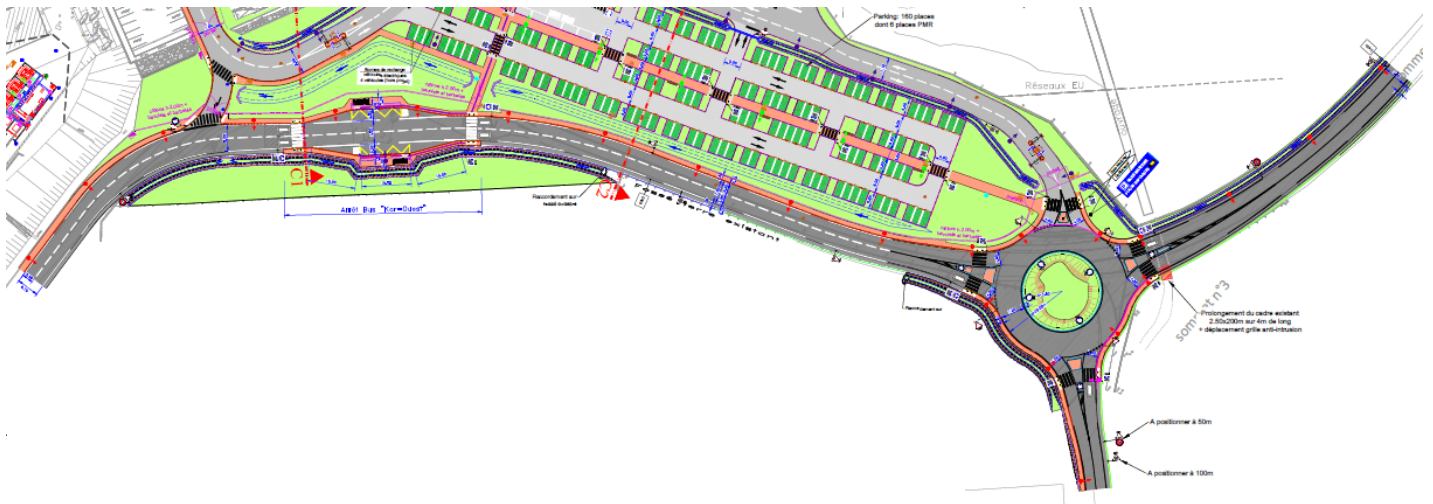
Plan d'aménagement de la rue Jesse Owens
